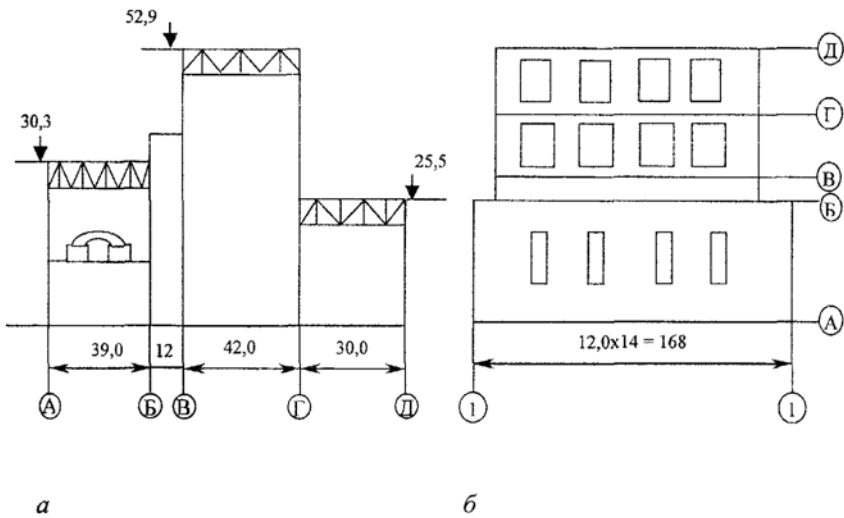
Главный корпус пылеугольной ТЭЦ ЗИТТ: а – разрез ГК; б – план ГК
